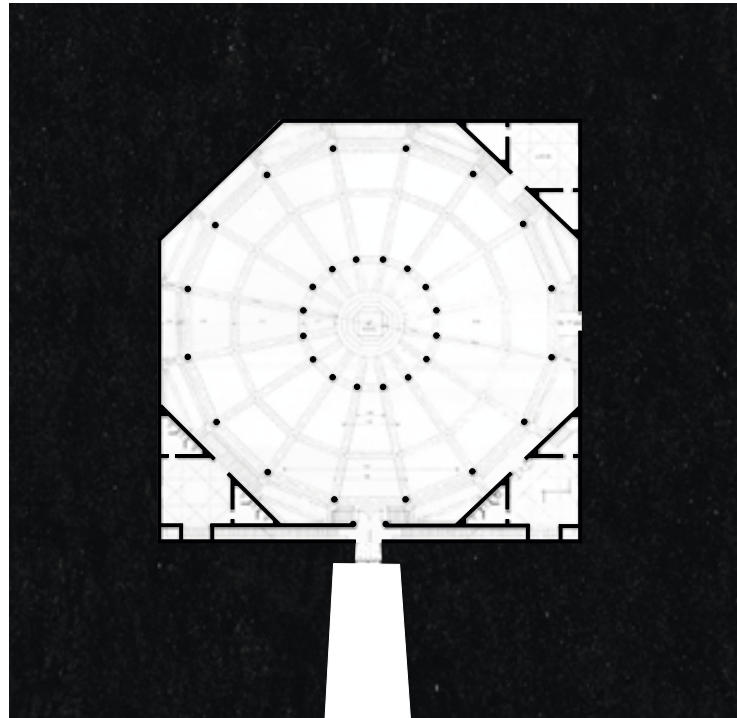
Grundriss Château Lafite Rothschild in Pauillac | 0 | 20m
